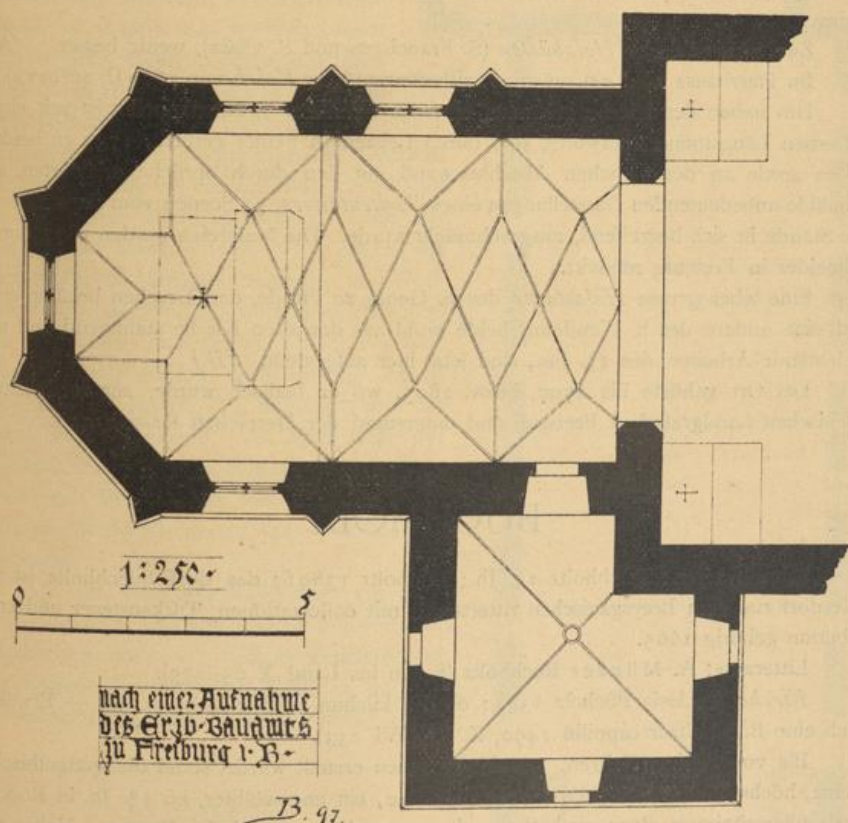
Bleibach. Pfarrkirche. Grundriss des Chores.
